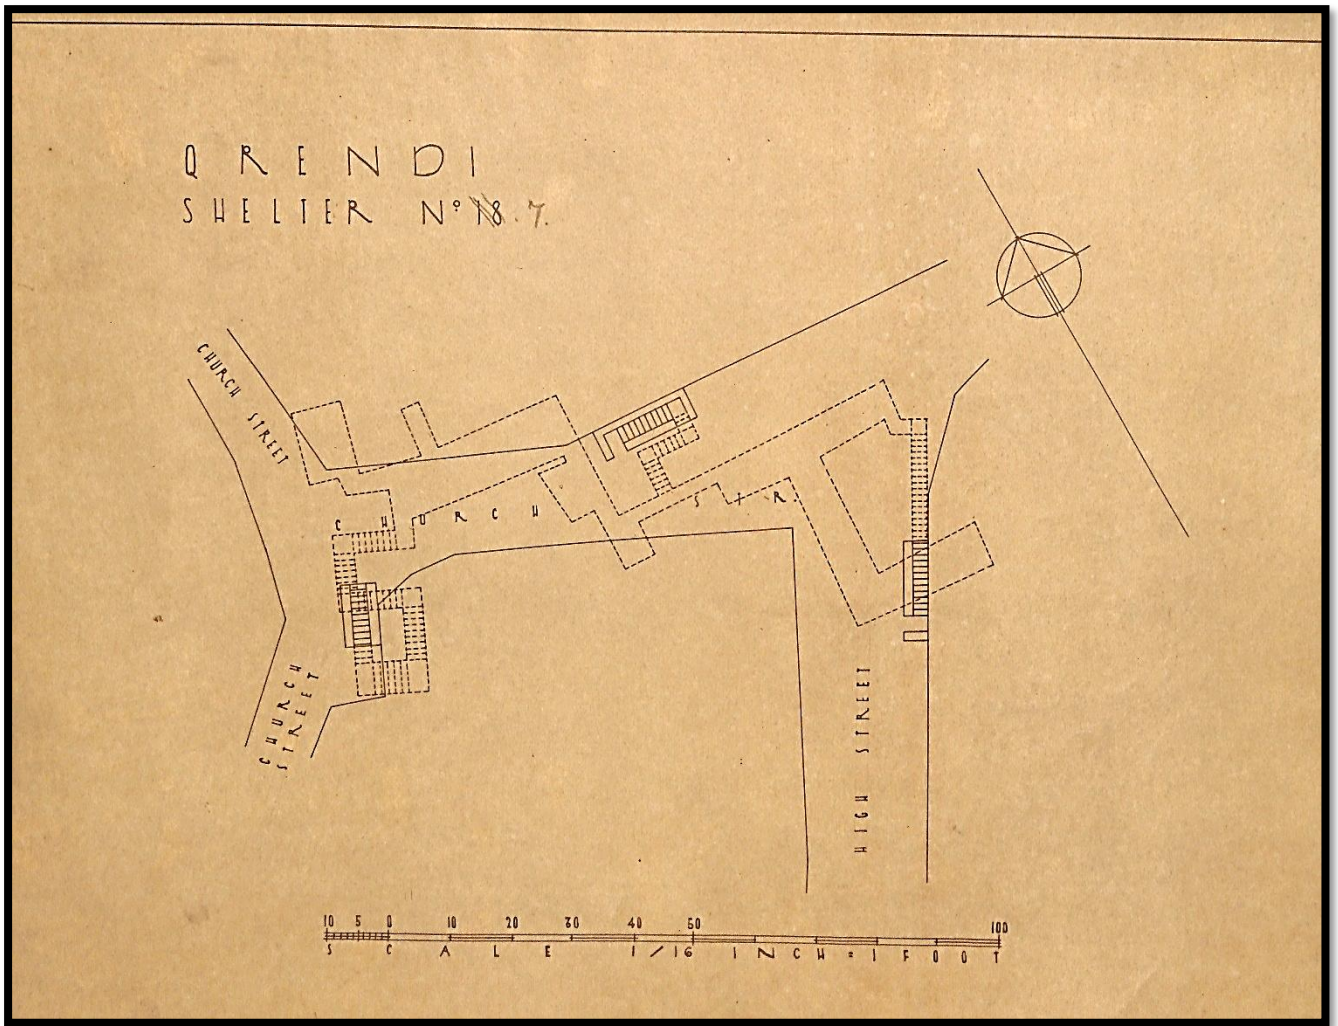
Planta do Abrigo nº7 "Church Str. – High Street."
